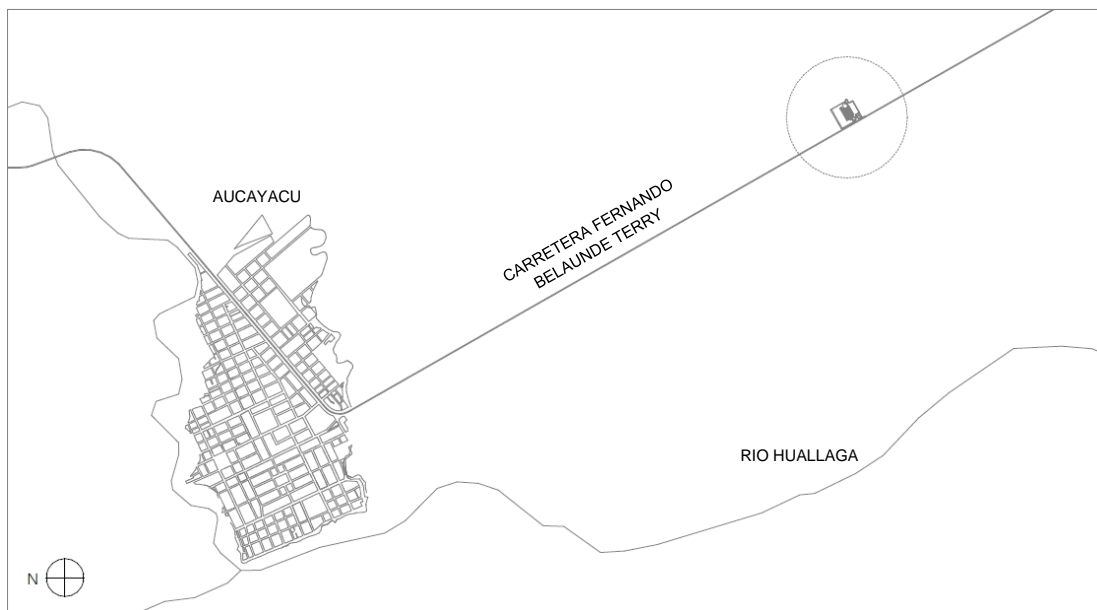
Planta de pelado y procesamiento de plátano – Ubicación
